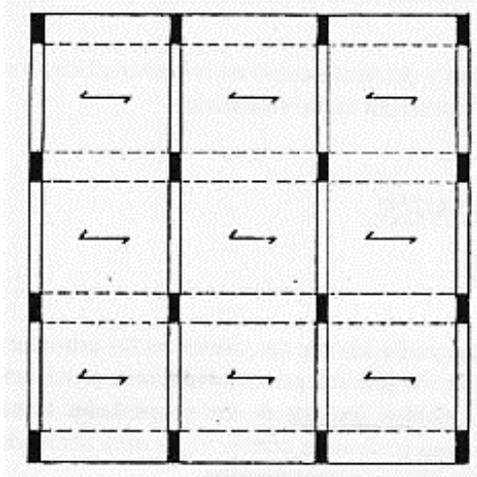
, Planta de edificio estructurado con criterio elástico, obsoleto para un país sísmico.
